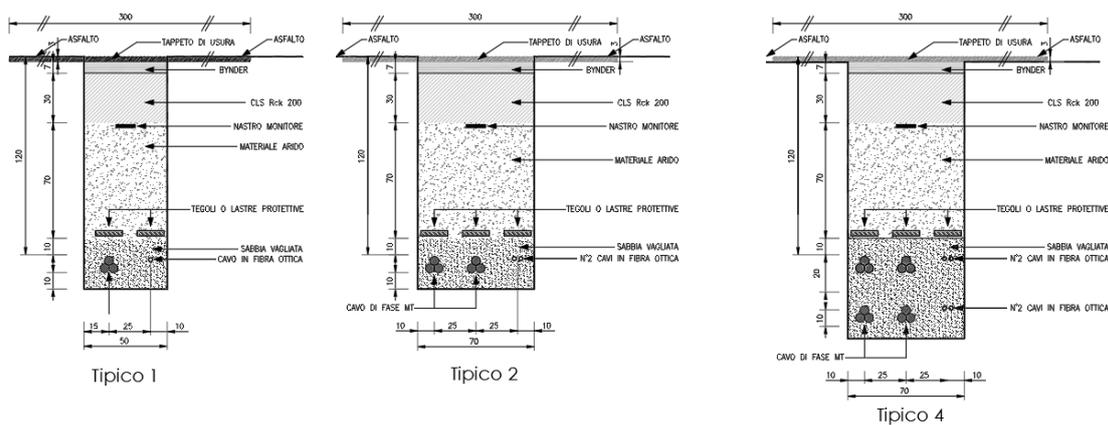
Sezioni tipo Disposizione Cavi MT Su Strade Asfaltate
